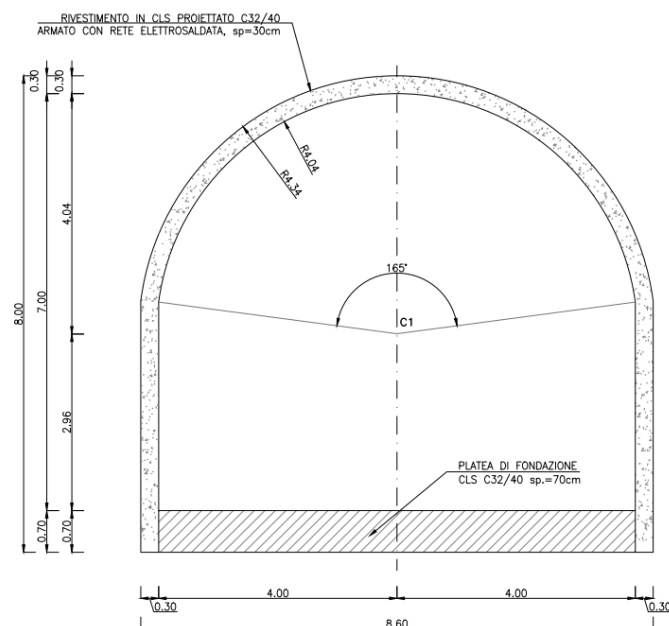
Sezione tipo GA 1 della galleria di accesso alla centrale
